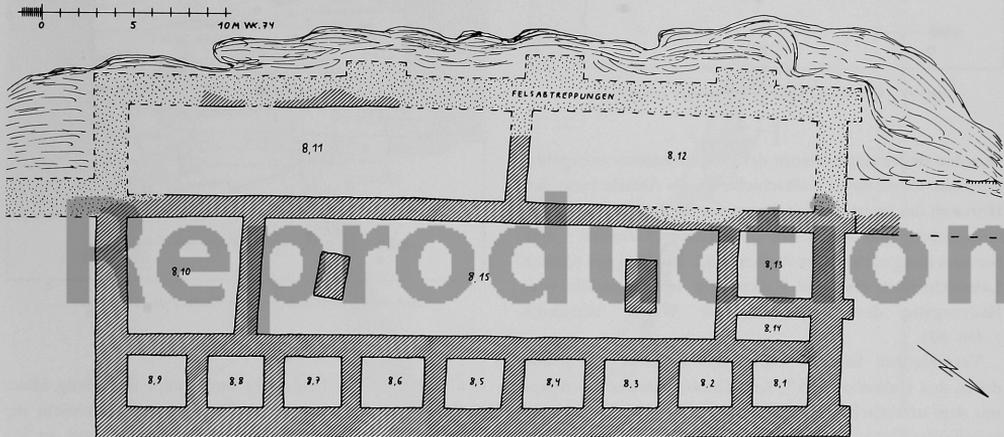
Unterburg, Grundrißschema des Hofhauses
